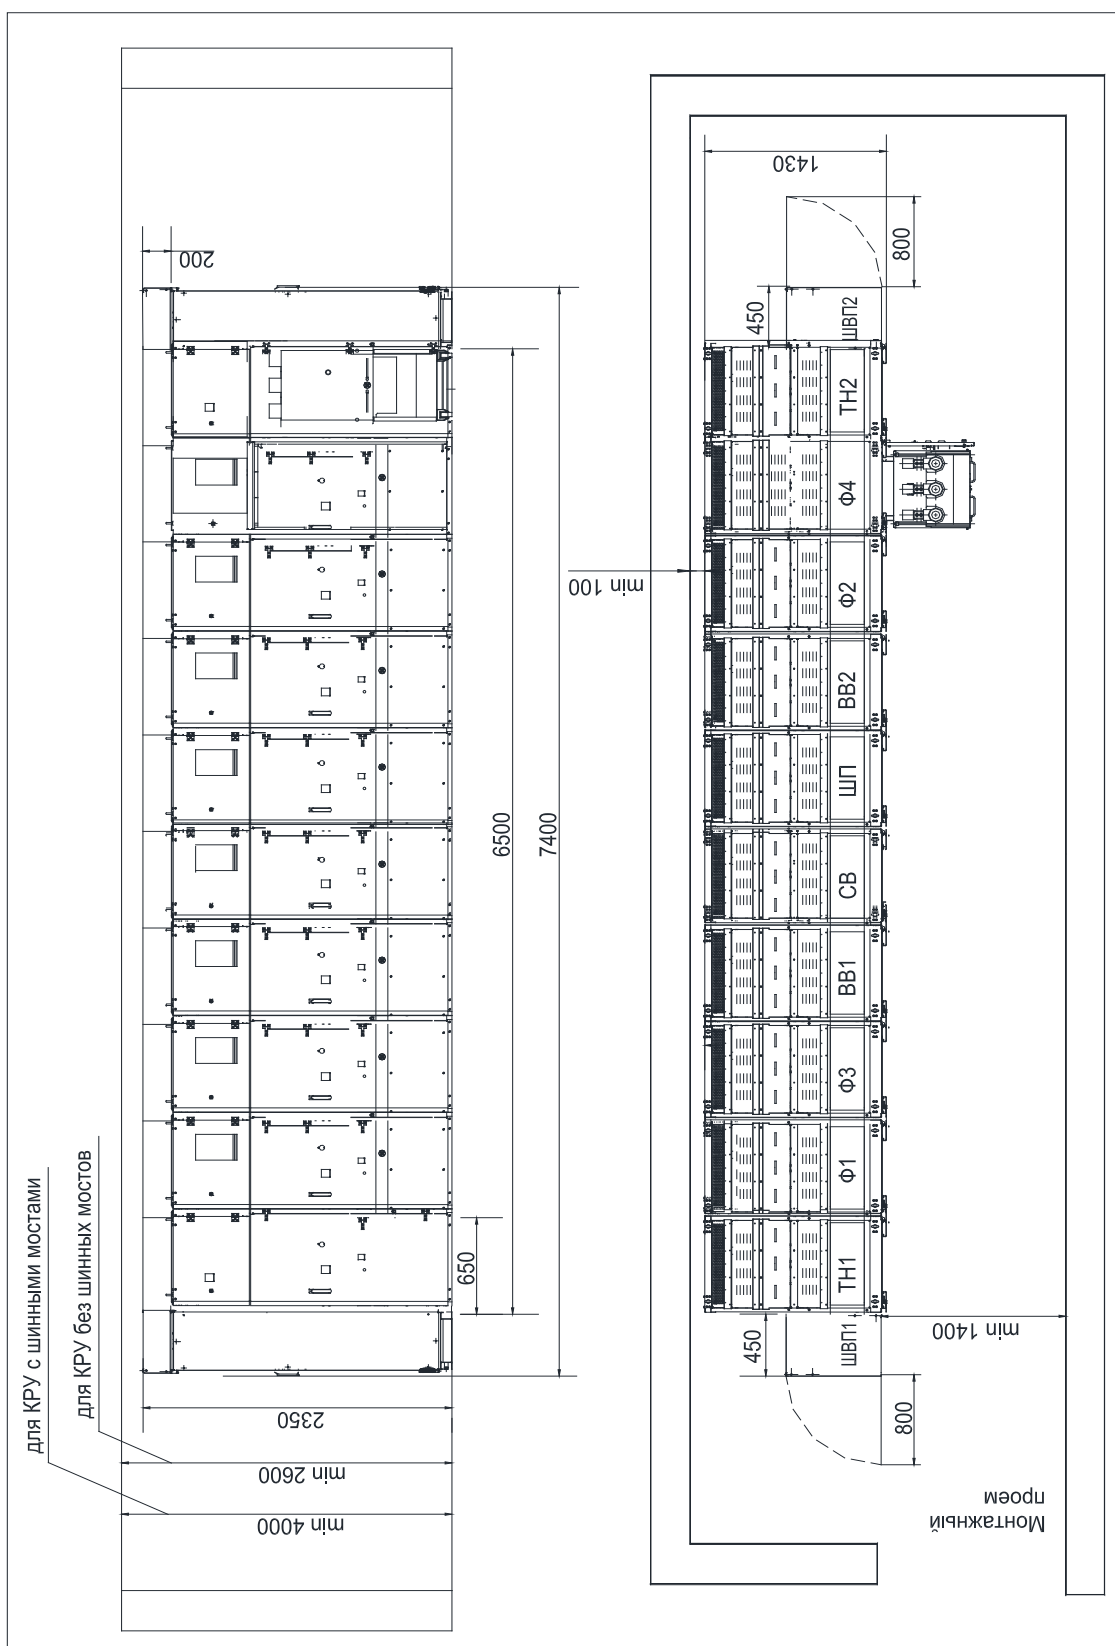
Двухрядное размещение шкафов КРУ фасадами наружу
